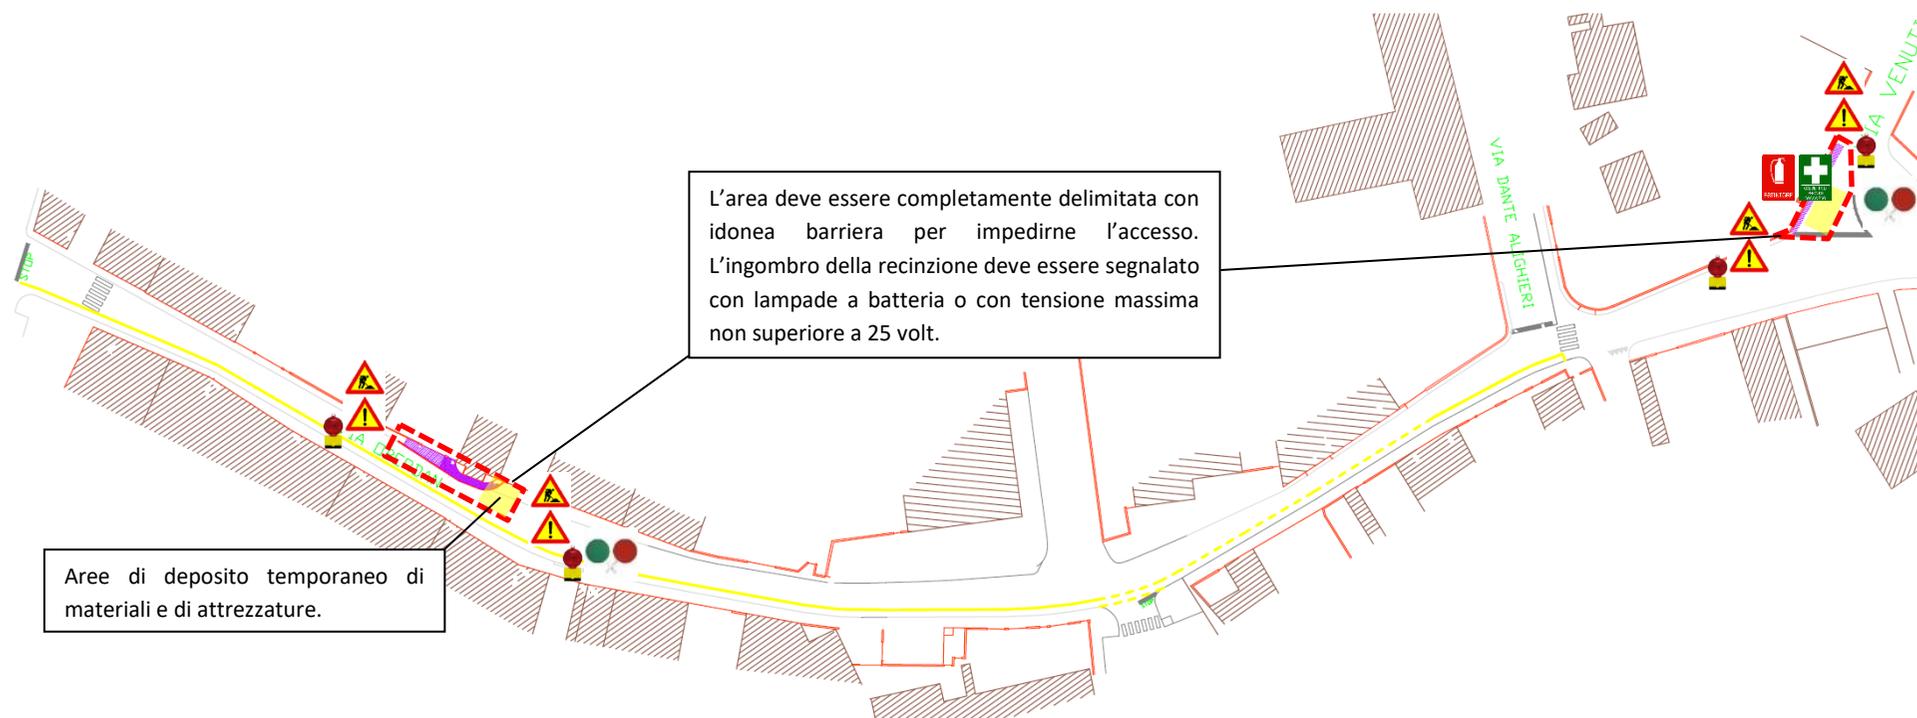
Planimetria di cantiere suddivisa nei tratti lungo Via G. Oberdan: allestimento e viabilità.
